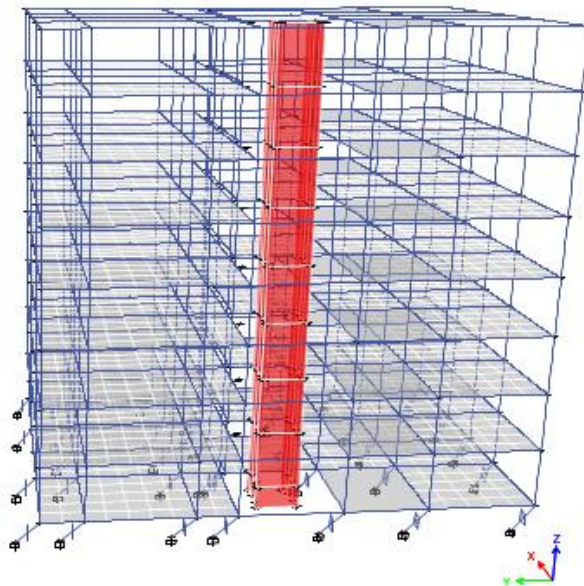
Vista de la estructura aislada en Y - Bloque 2
